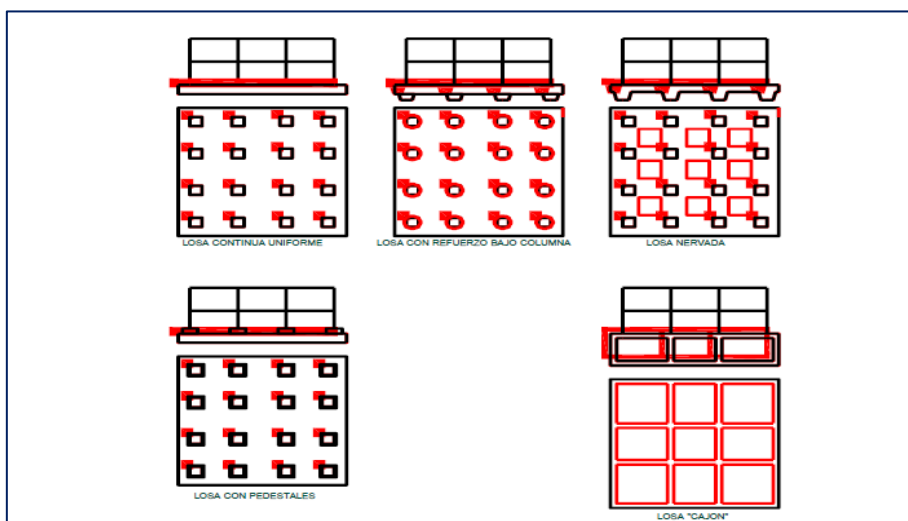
Tipos de emparrillado de cimentación. (Fuente: Morales Curo 2018)
